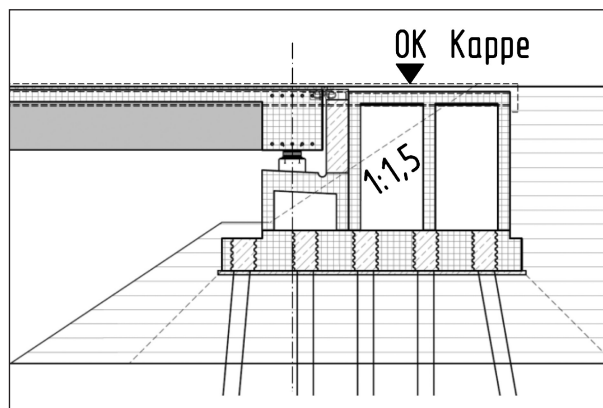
Schnitt, Gründung auf Spannbetonrammpfählen
